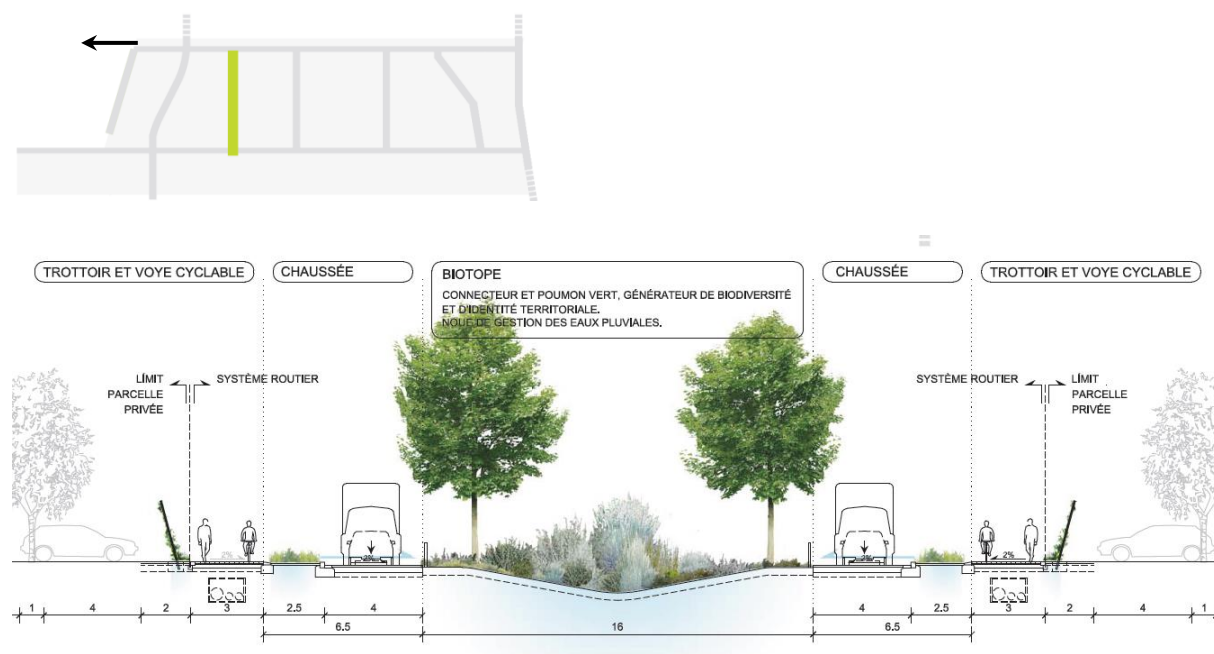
Coupe de principe de la rue de Balmes (Extrait plan guide BAU juin 2016)
